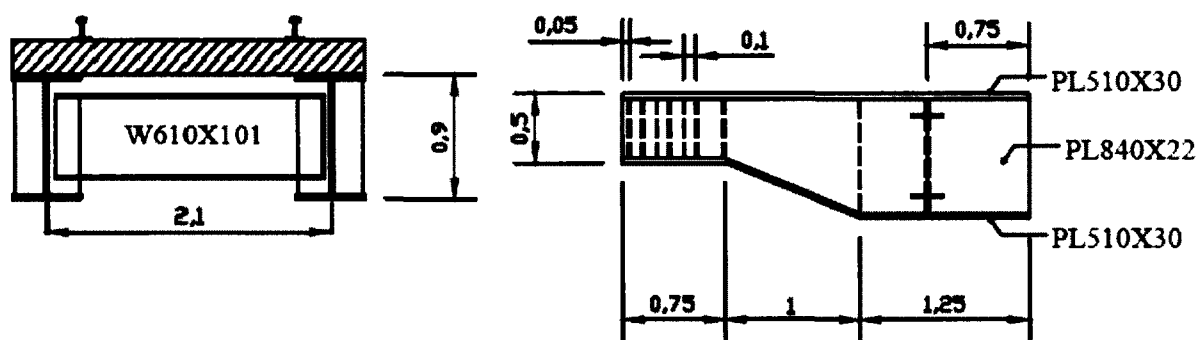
Pont bi-poutres - Section transversale et élévation - Section A-2
